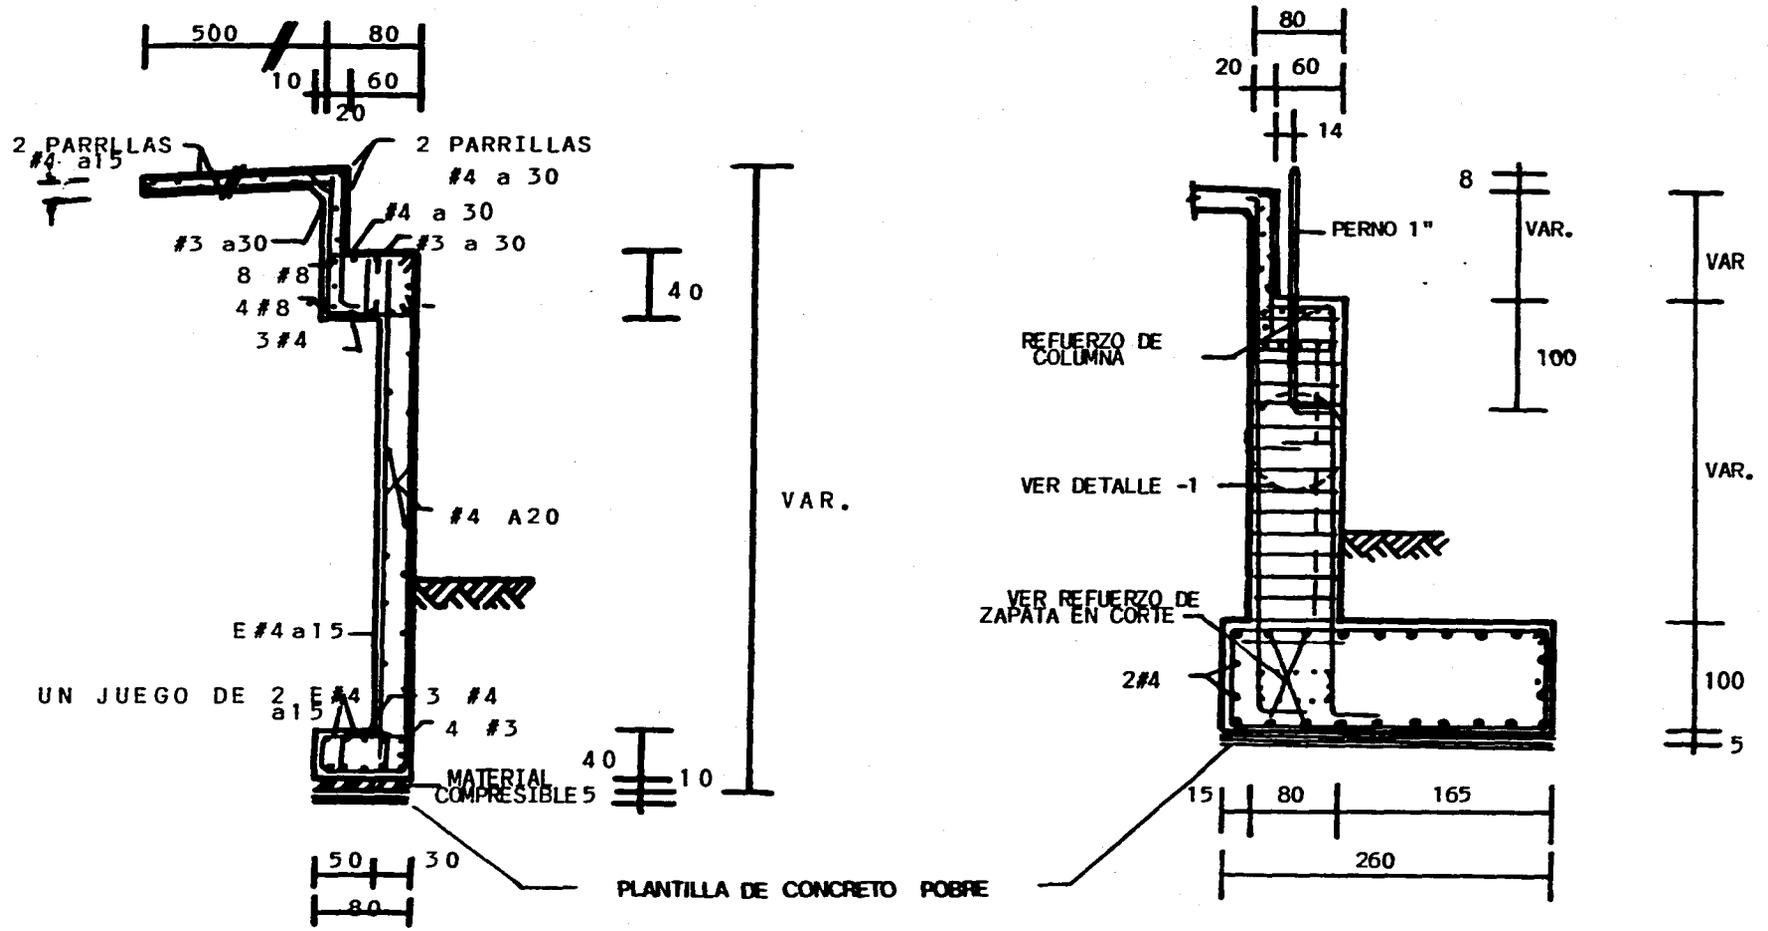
CORTE DEL MURO ESTRIBO
